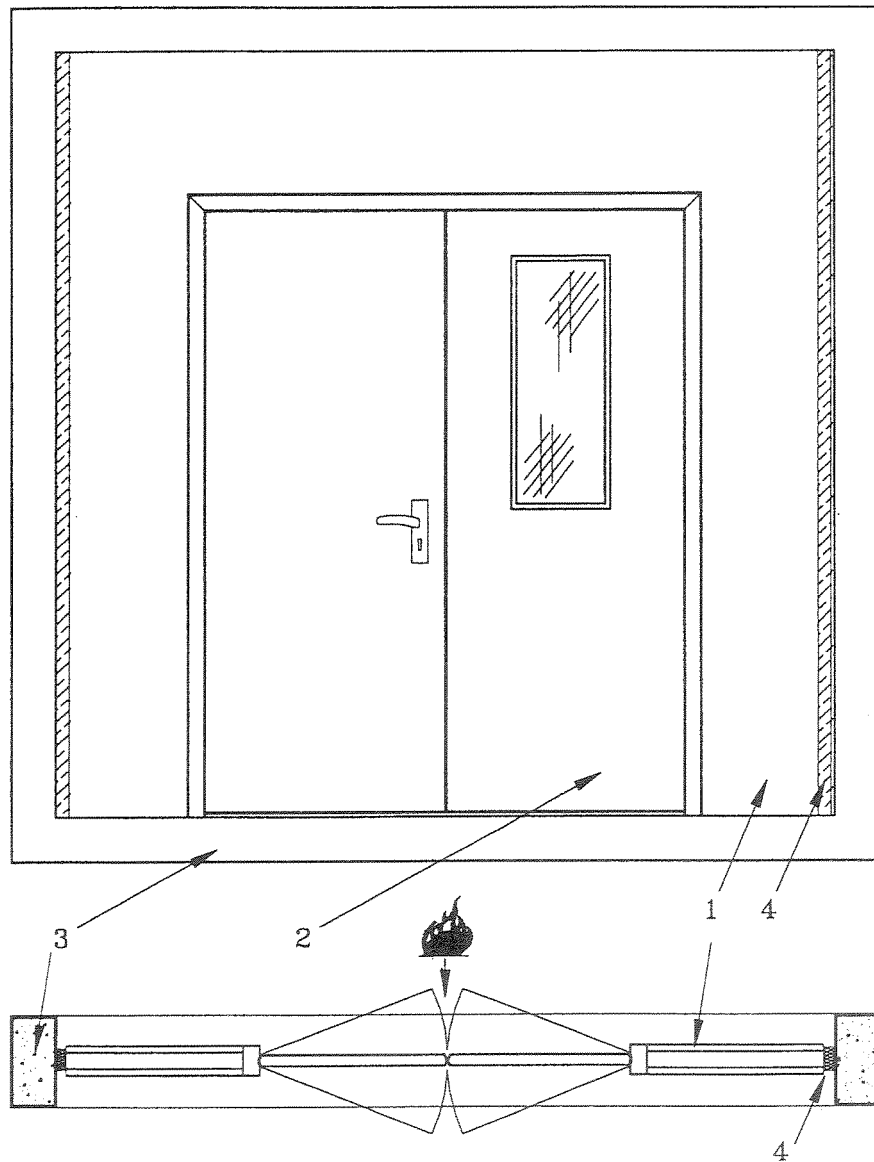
Ejemplo de sección horizontal de obra soporte normalizada de tipo flexible
